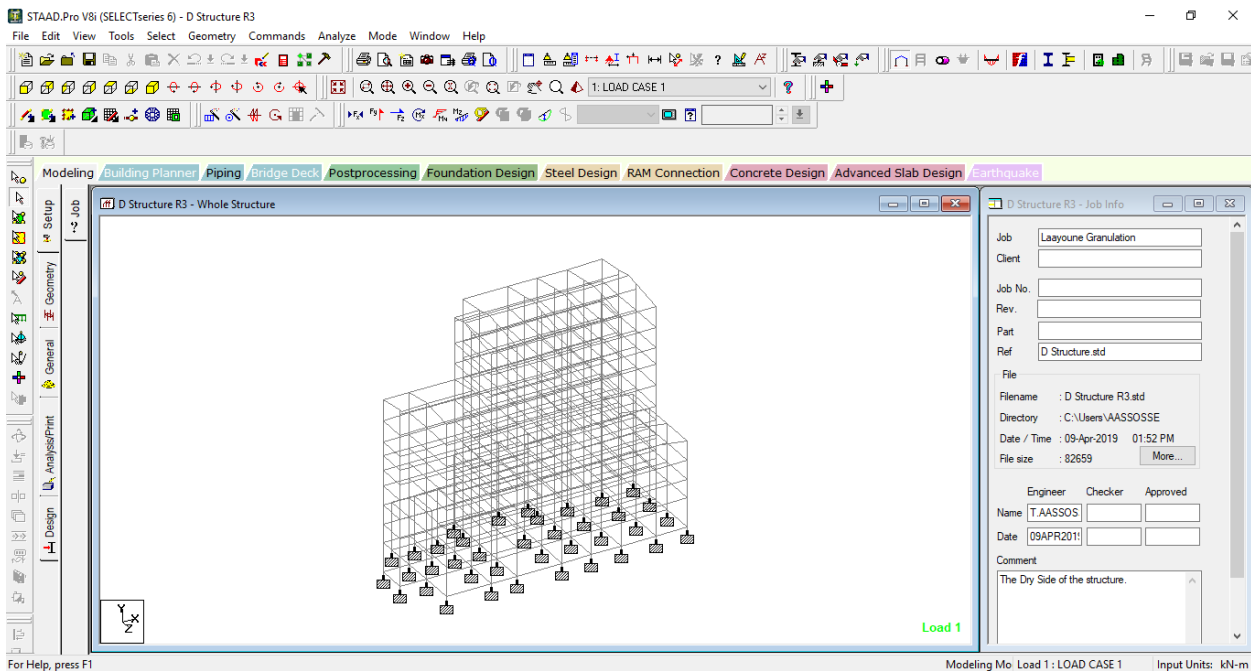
La structure du bâtiment sur STAAD PRO
